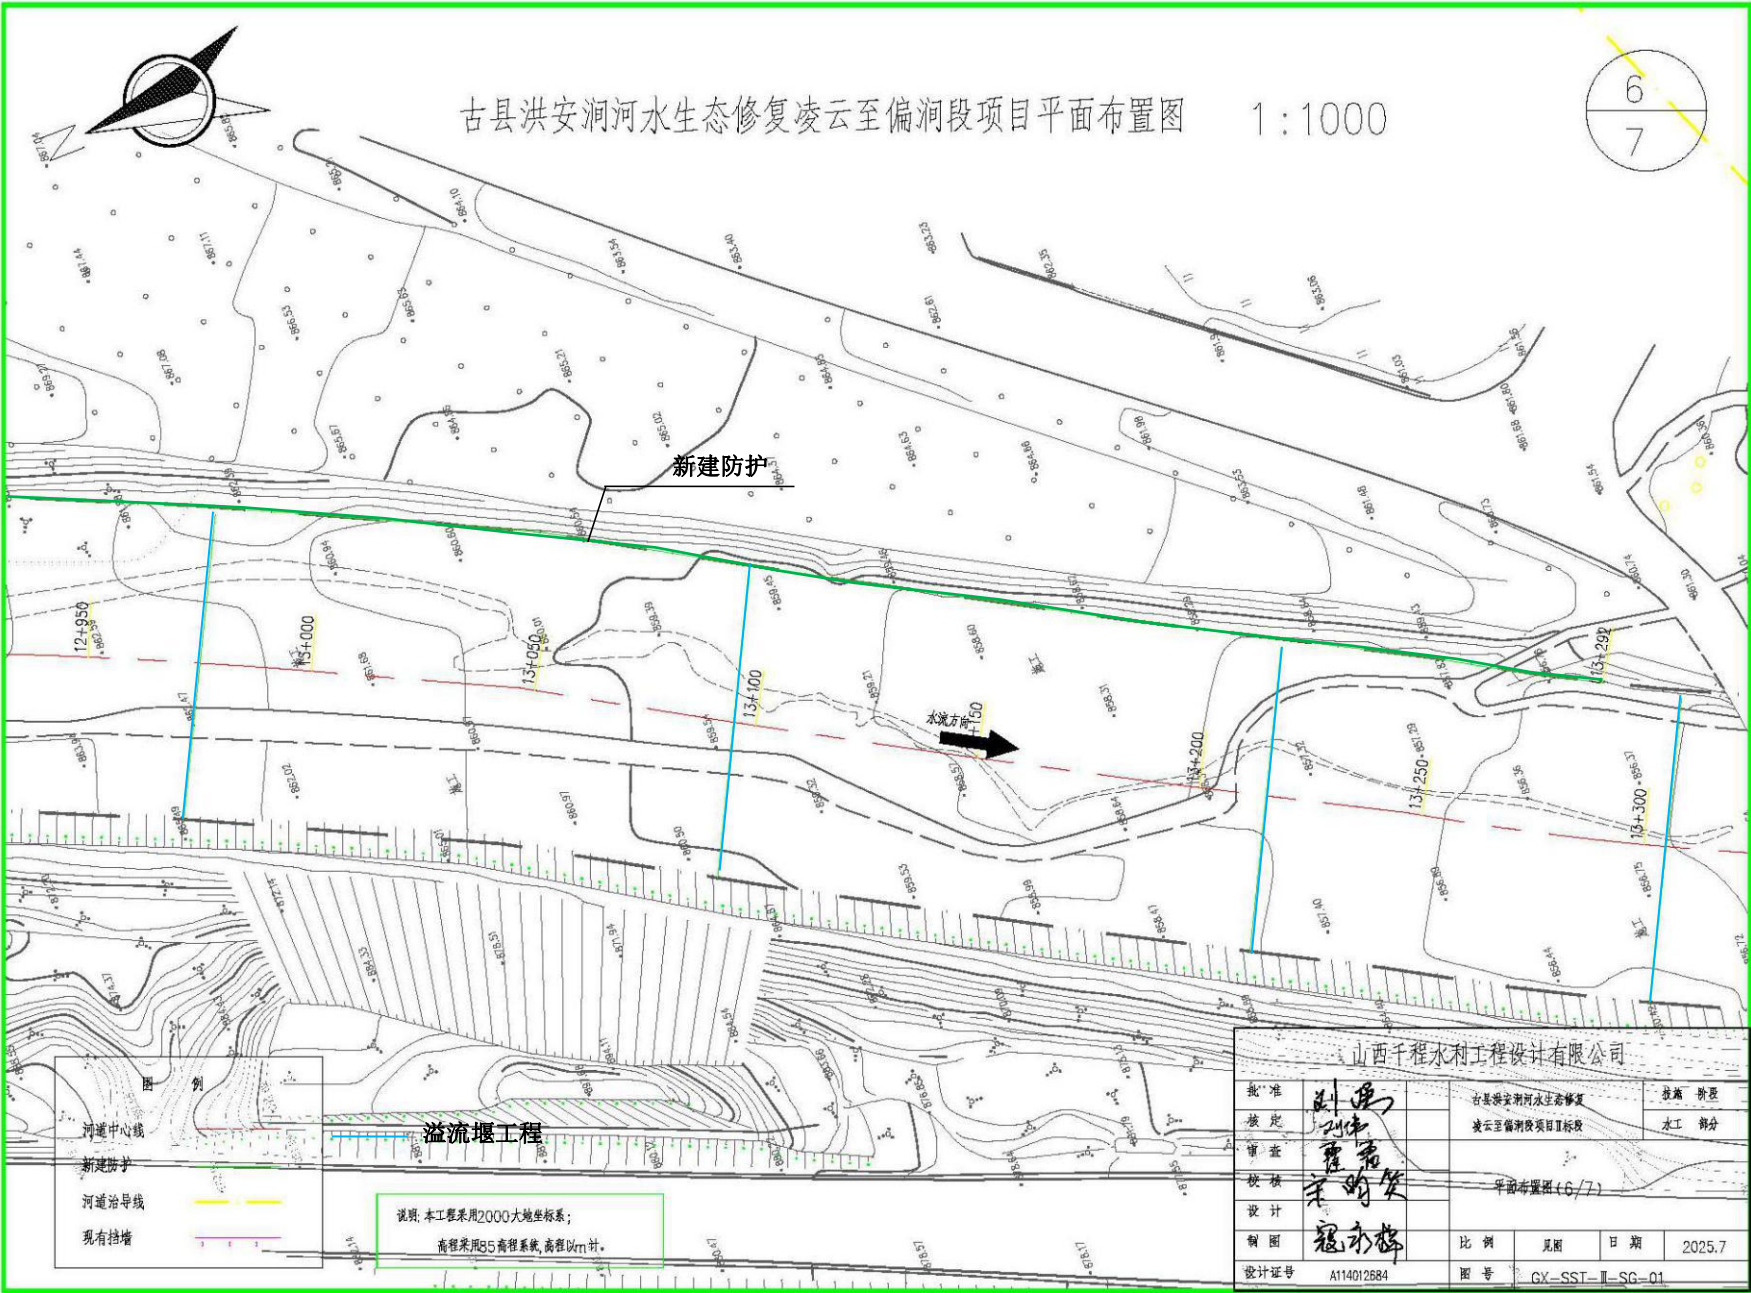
(10) 工程总平面布置图(桩号 12+900-13+300)
